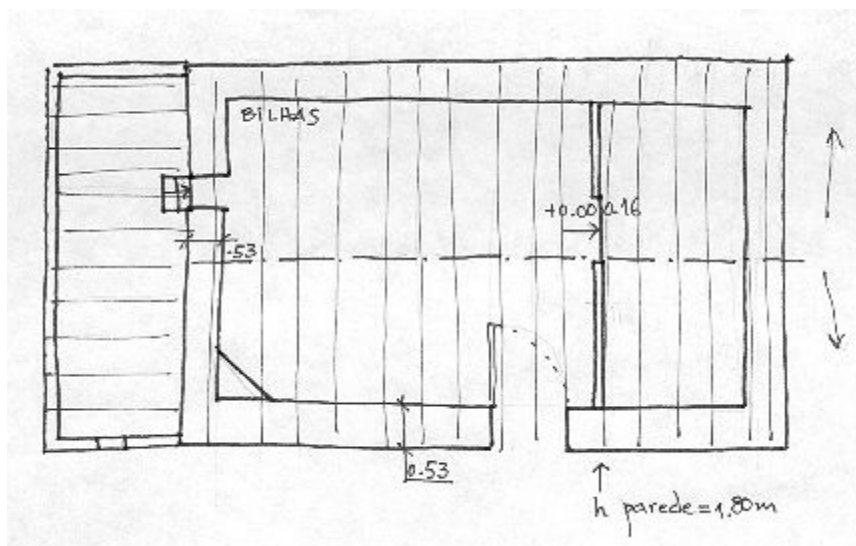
Planta da casa do Sr. Gualdino (sem escala).
